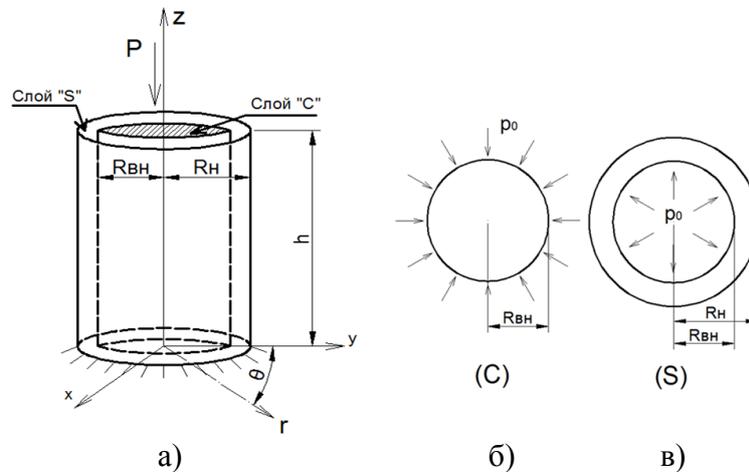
а) трубобетонная свая, б) сечение бетонного ядра сваи, в) сечение стальной оболочки сваи
